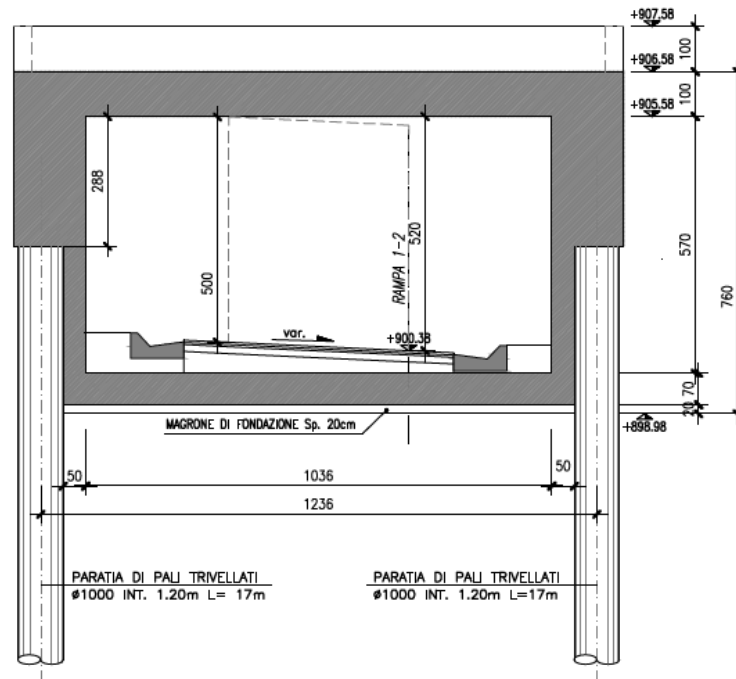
Sottopasso ST01– Sezione trasversale B-B
